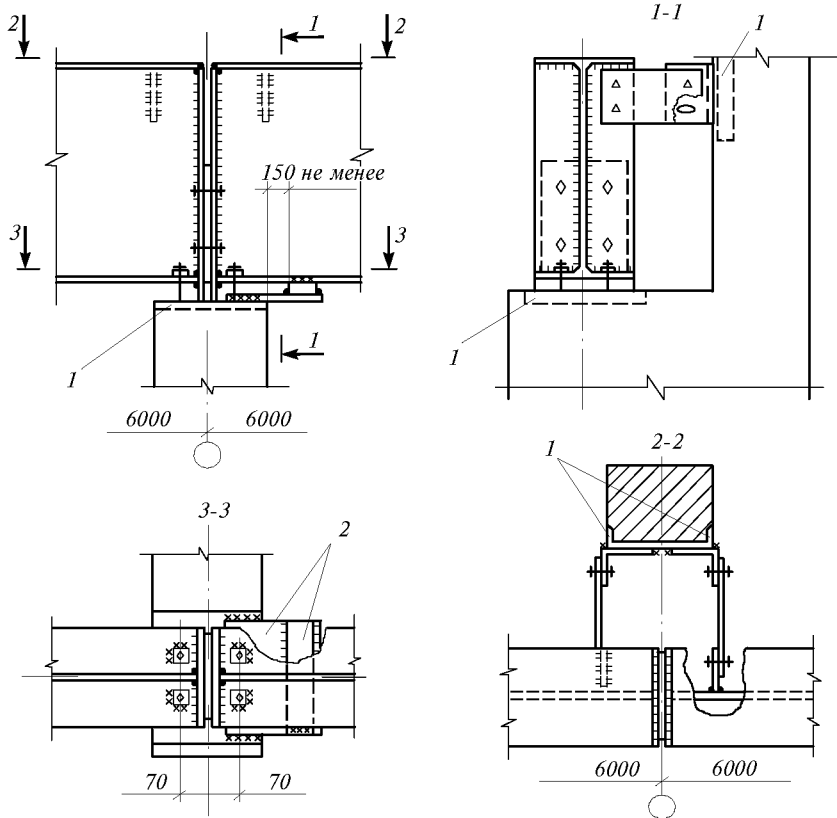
Опирание разрезных подкрановых балок на железобетонную колонну
